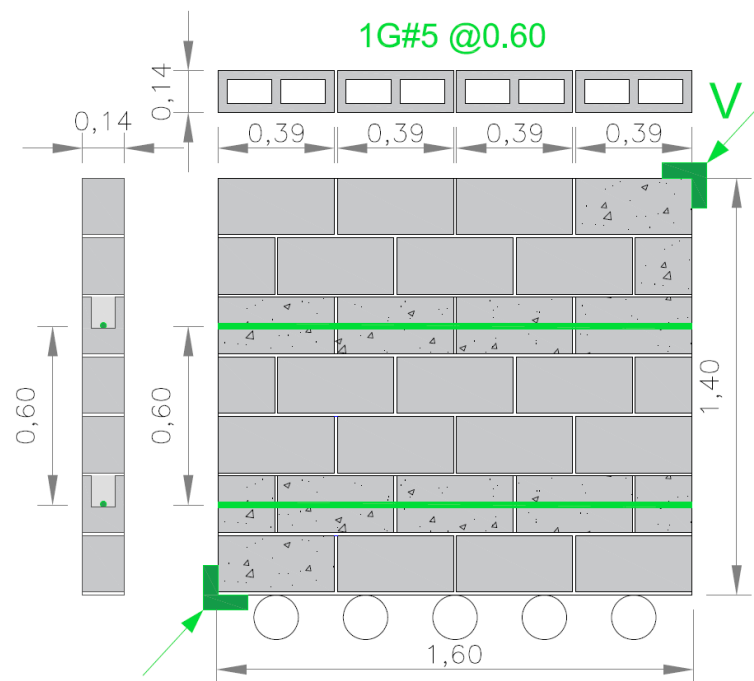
Configuración del refuerzo del muro MD-1#5/60
